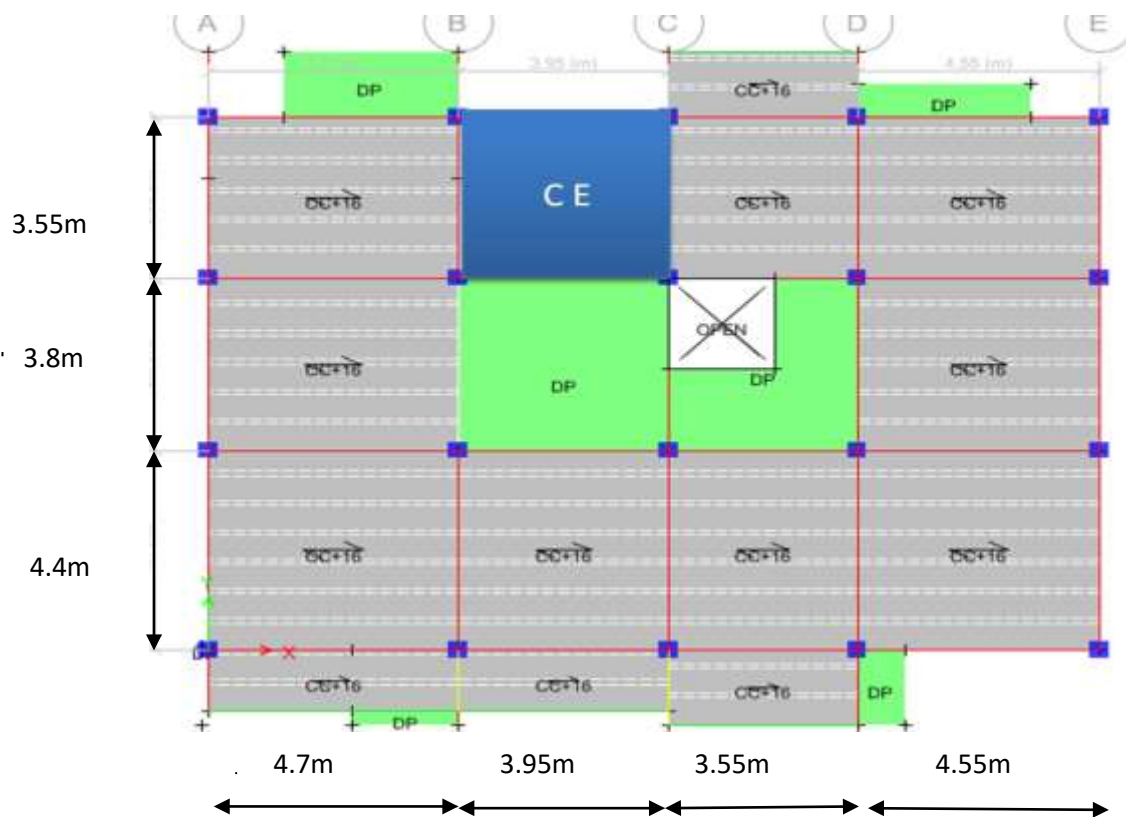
Plan de disposition des poutrelles (Etage 01 à 05)
